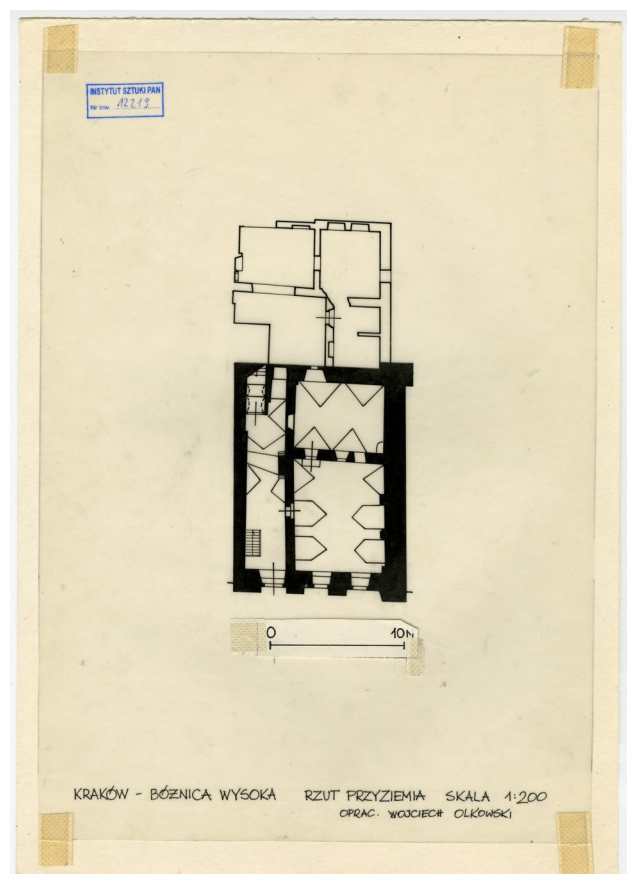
Grundriss EG, 1960er Jahre
